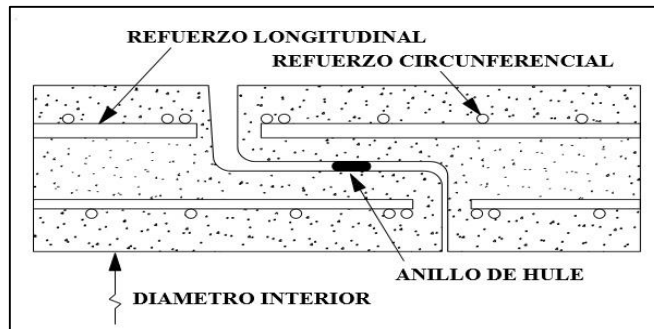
Unión espiga-campana en tuberías de concreto sin cilindro de acero.
